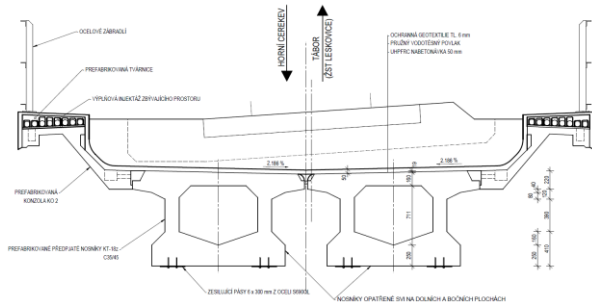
Detail napojení prefabrikované konzoly k nosné konstrukci – původní dokumentace prefabrikovaných konzol
